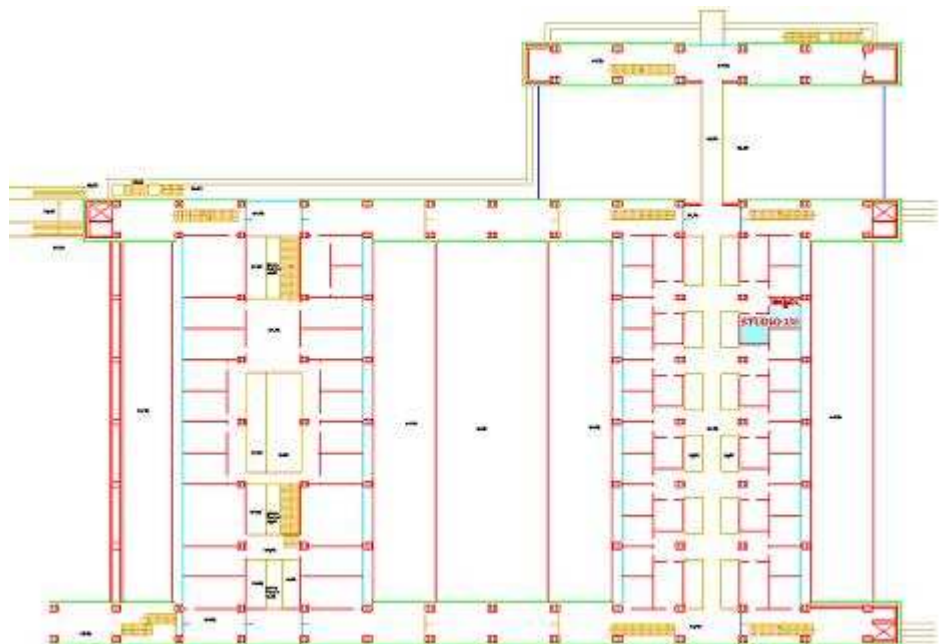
Edificio 18, collocazione in pianta dello Studio n°130
